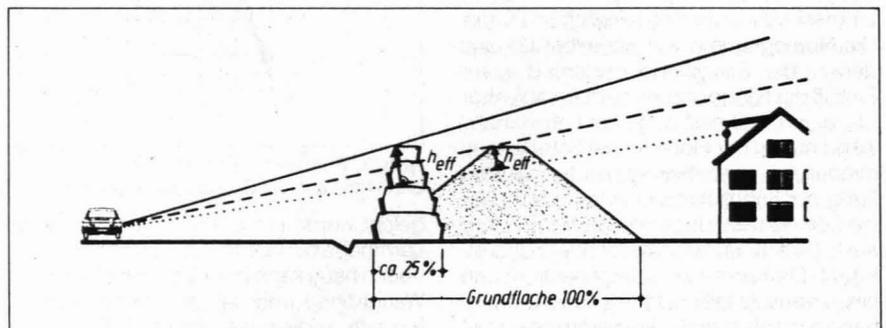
Steilwall im Vergleich zum herkömmlichen Erdwall
